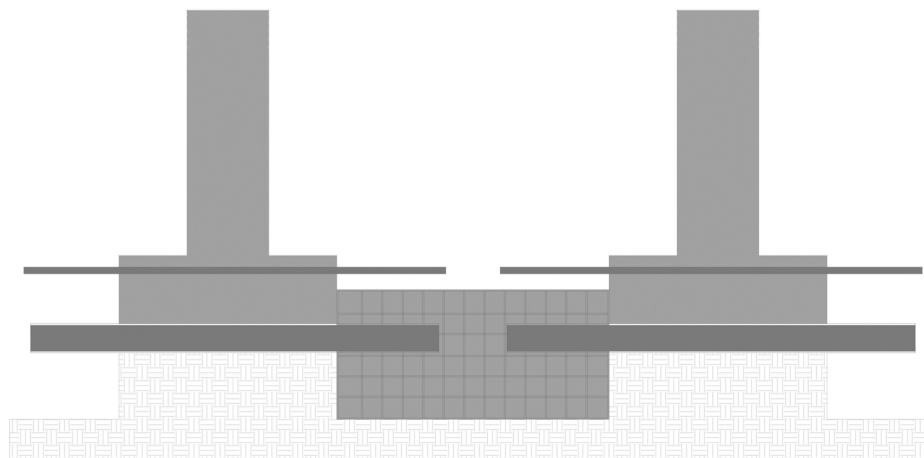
38 – Infissione orizzontale sottofondale con putrelle di tipo HEB, messa in opera dell'armatura e stesura della prima platea di fondazione
